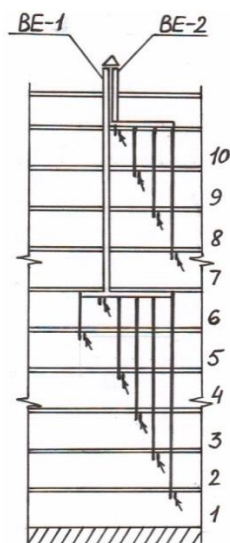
Схема системы естественной вентиляции 10-ти этажного дома
